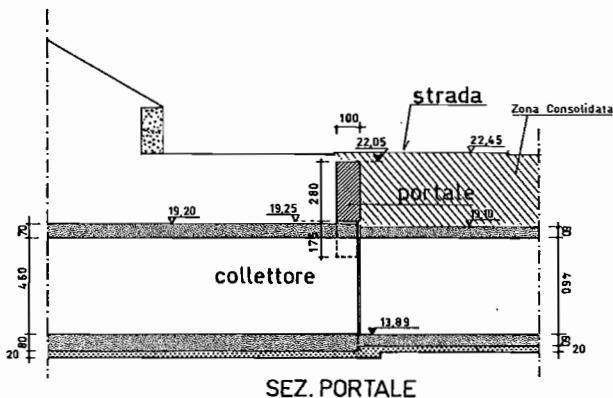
Sezione longitudinale della galleria in corrispondenza del secondo intervento di consolidamento.
